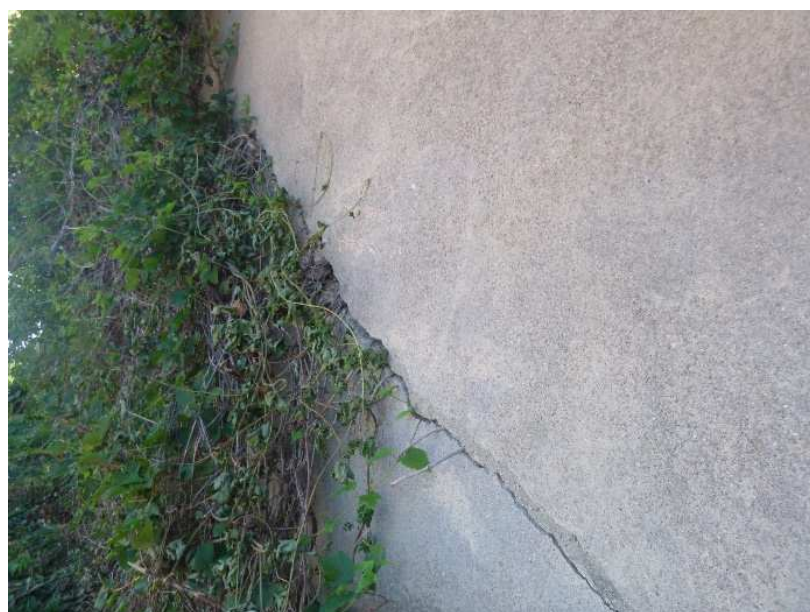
Fissure verticale d'ouverture proche du cm en extrémité de mur (796m)
